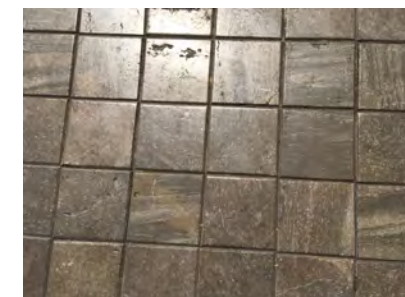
Pavimento utilizado en la calle Marqués de Dos Aguas
